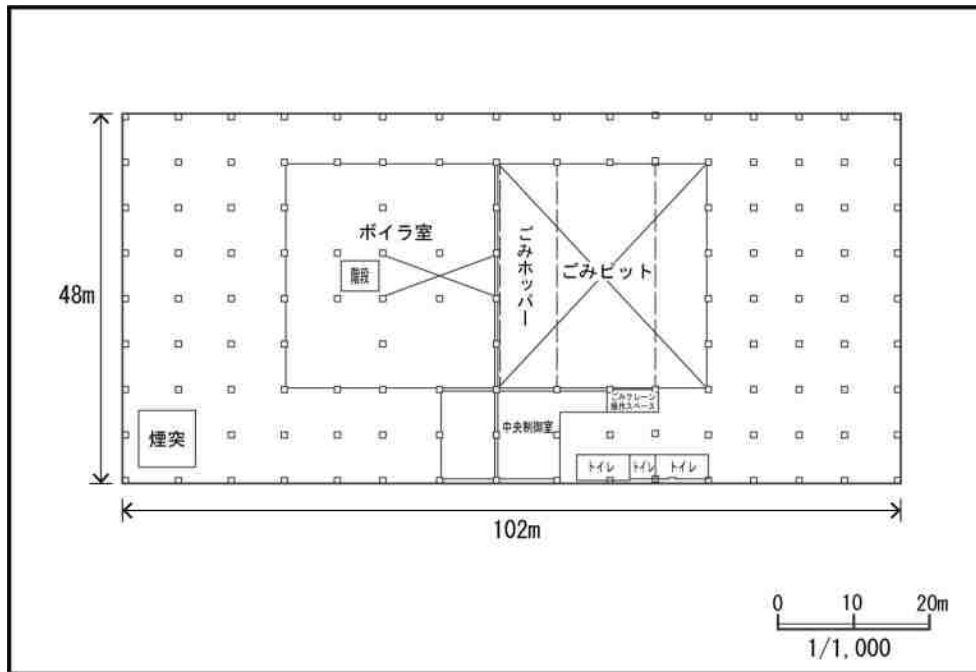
(5) 新施設の平面図（新焼却処理施設 4 階）
